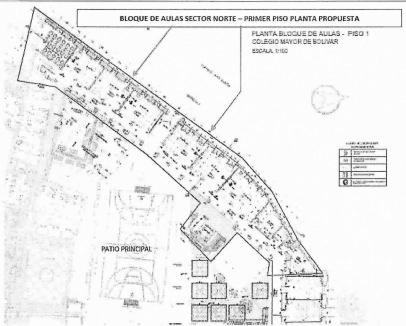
Planta Arquitectónica General propuesta Primer piso Bloque de Aulas sector Norte. Fuente: DP. Construarquitect. SAS, 2021.
